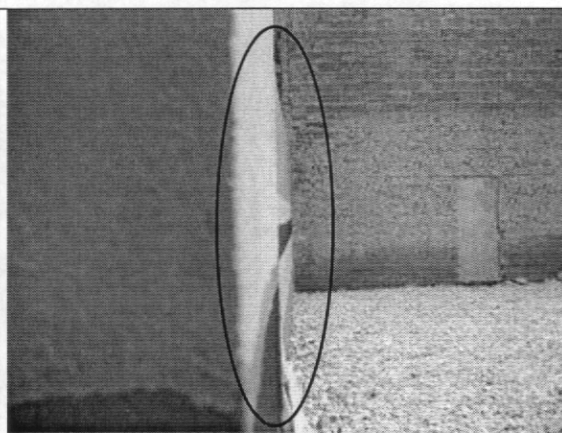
Vista de perfil muro, no hay pérdida de verticalidad
